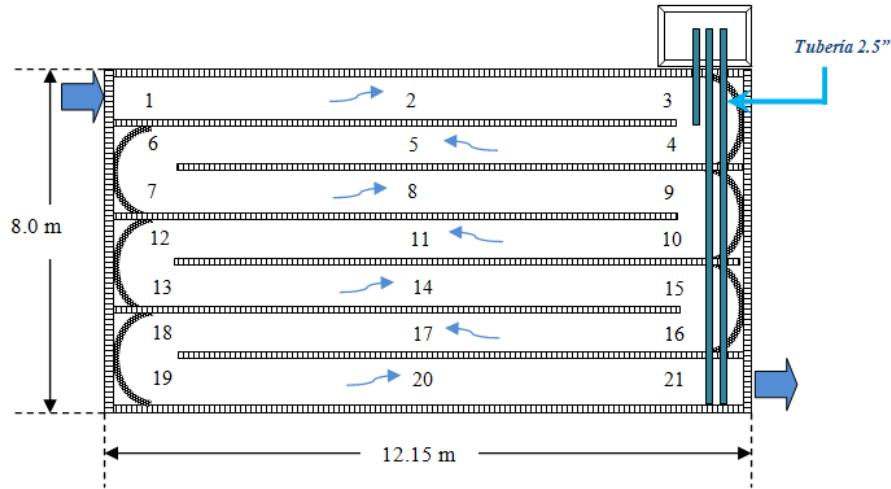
Vista en planta de la laguna y su sistema de desazolve
